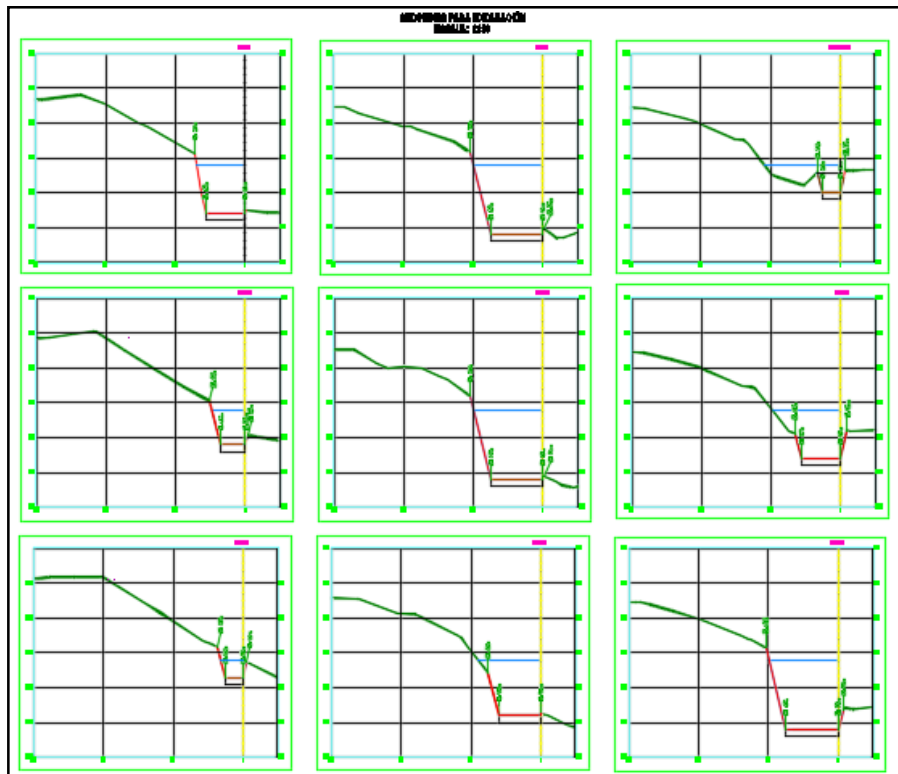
Secciones transversales para excavación muro La Pradera – Girón
